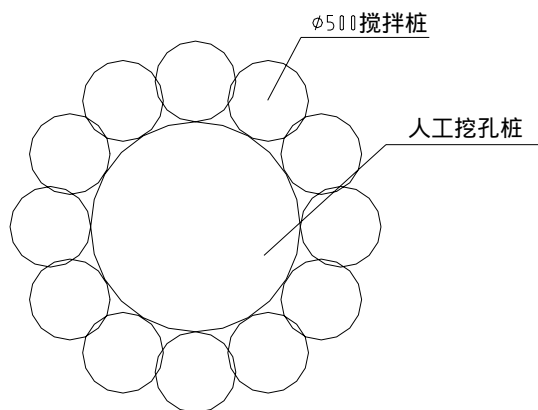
人工挖孔桩止水帷幕搅拌桩平面布置图
